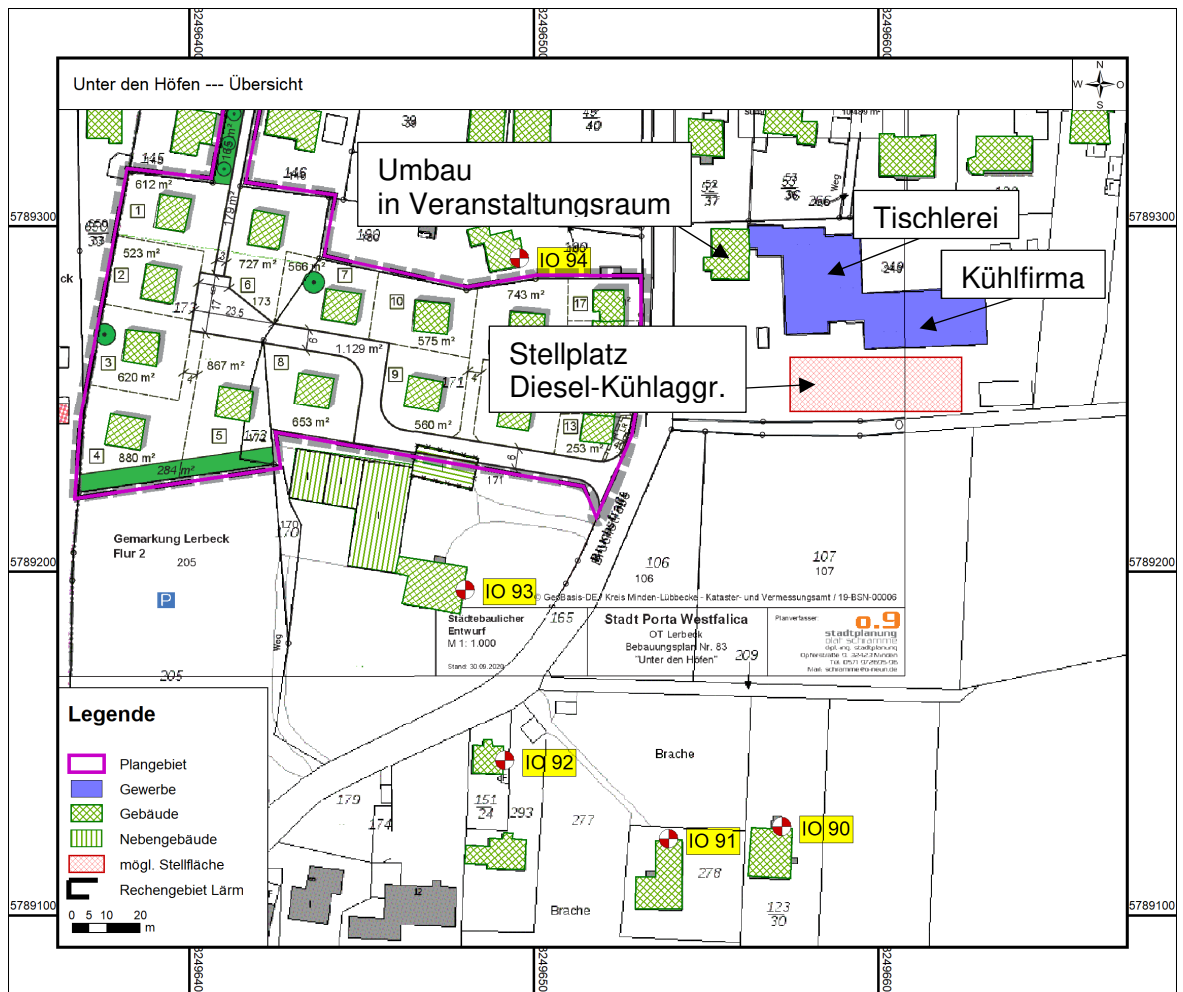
Ausschnitt Lageplan – Bestandsituation; Gewerbe
